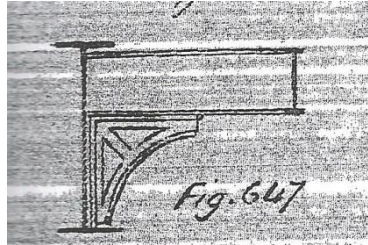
Croquis de escuadra de refuerzo. Fuente: (Anónimo, 1909).
